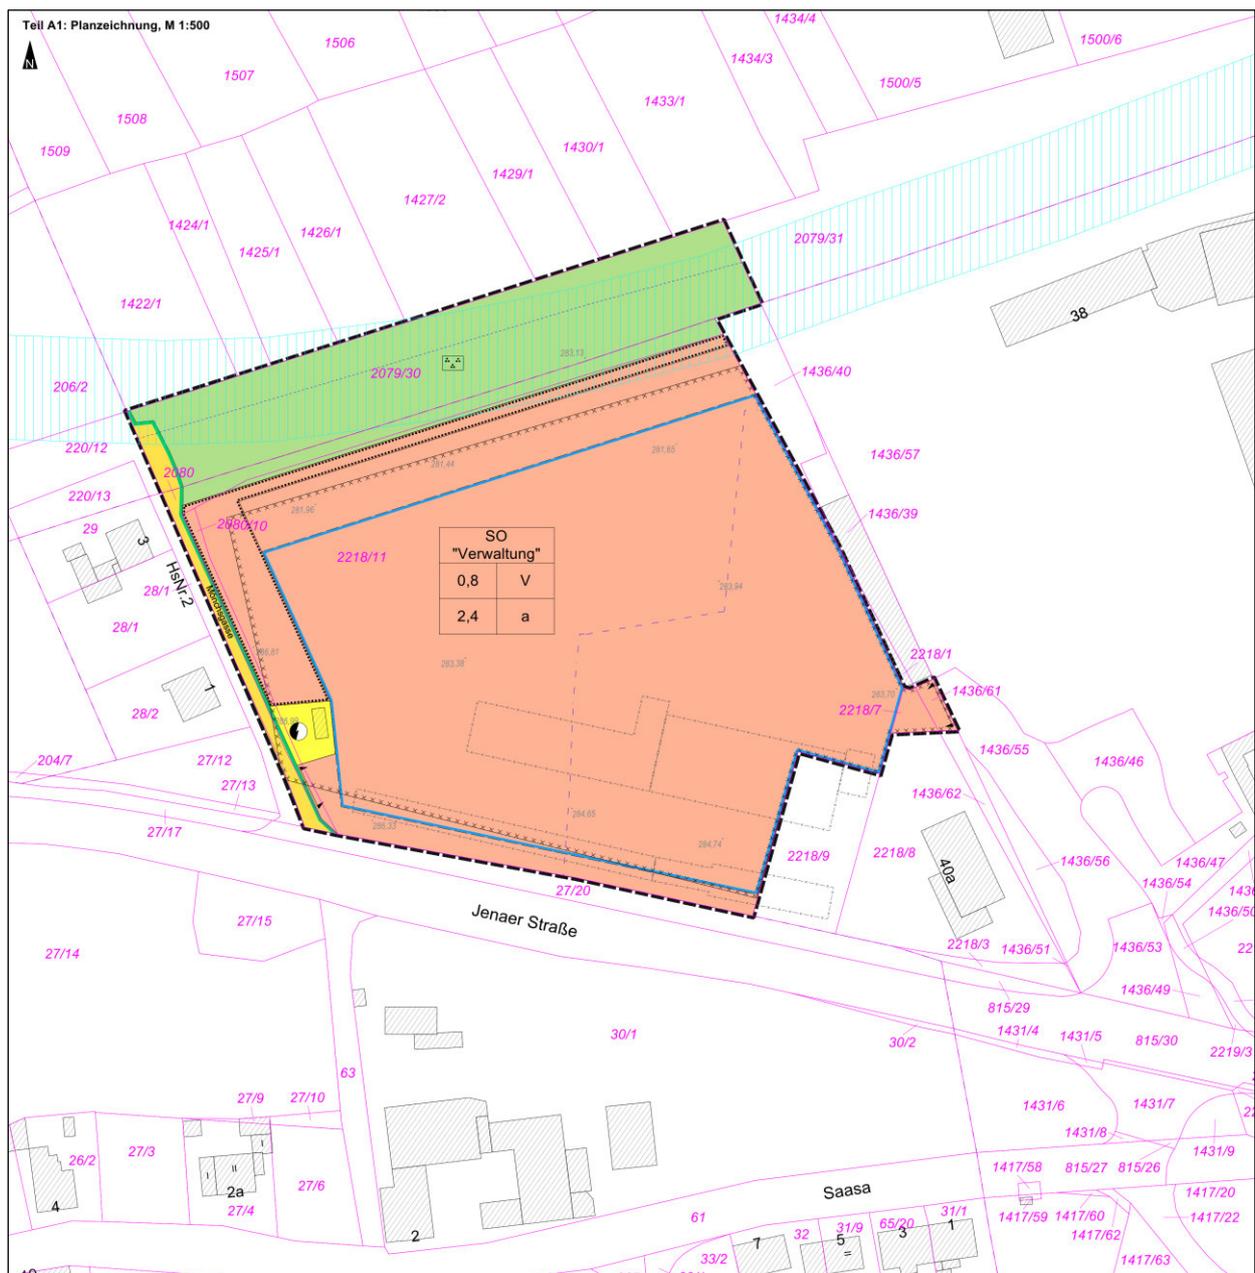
Lageplan zum Bebauungsplan gemäß Entwurf (Stand 05.04.2024)
